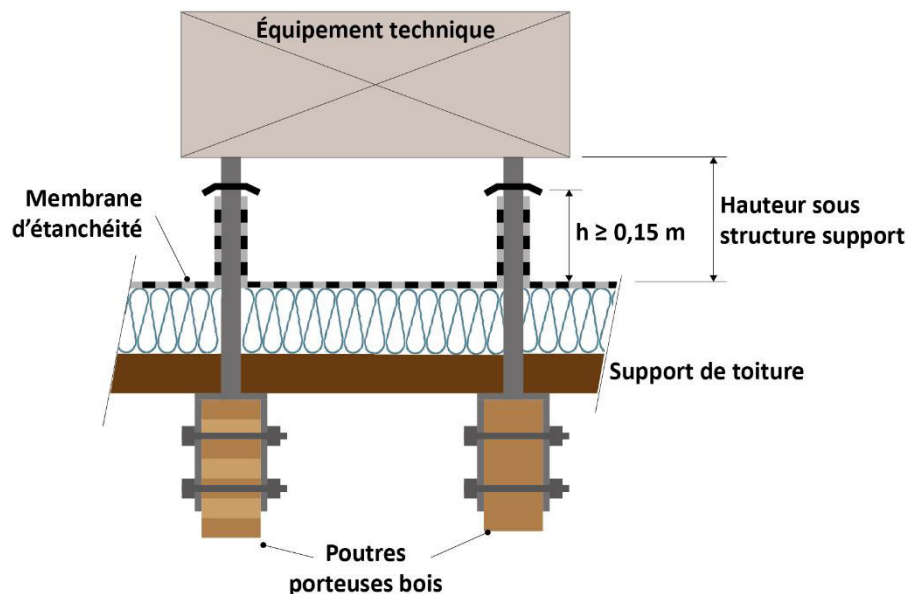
Exemple d'interface entre la charpente bois et un équipement en toiture
